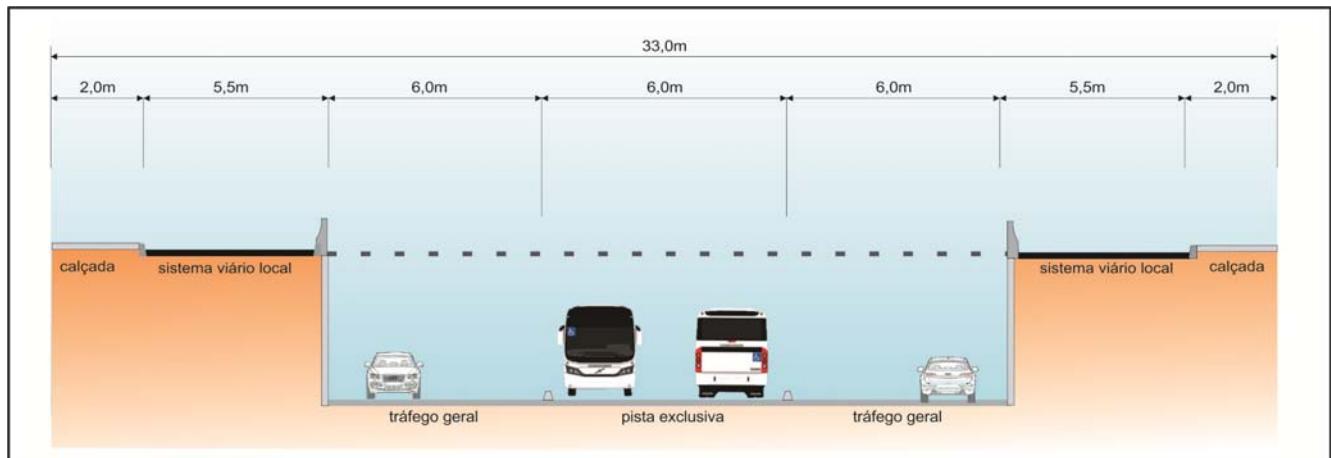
Seção transversal passagem inferior Rua 90 x Avenida 136
